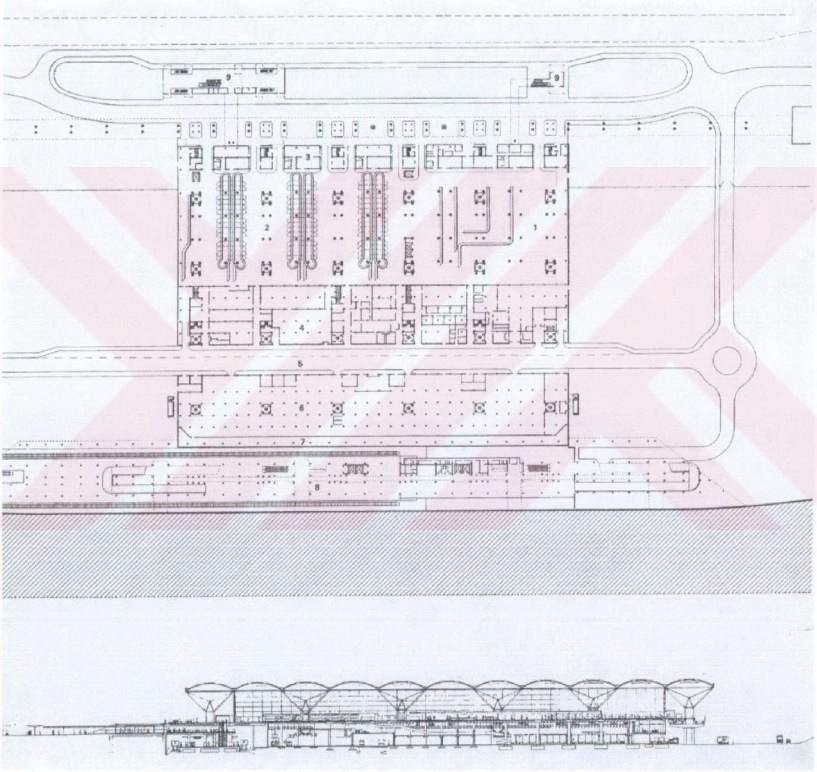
Alttan gelen yolcu katı planı, üstten giden yolcu katı planı
